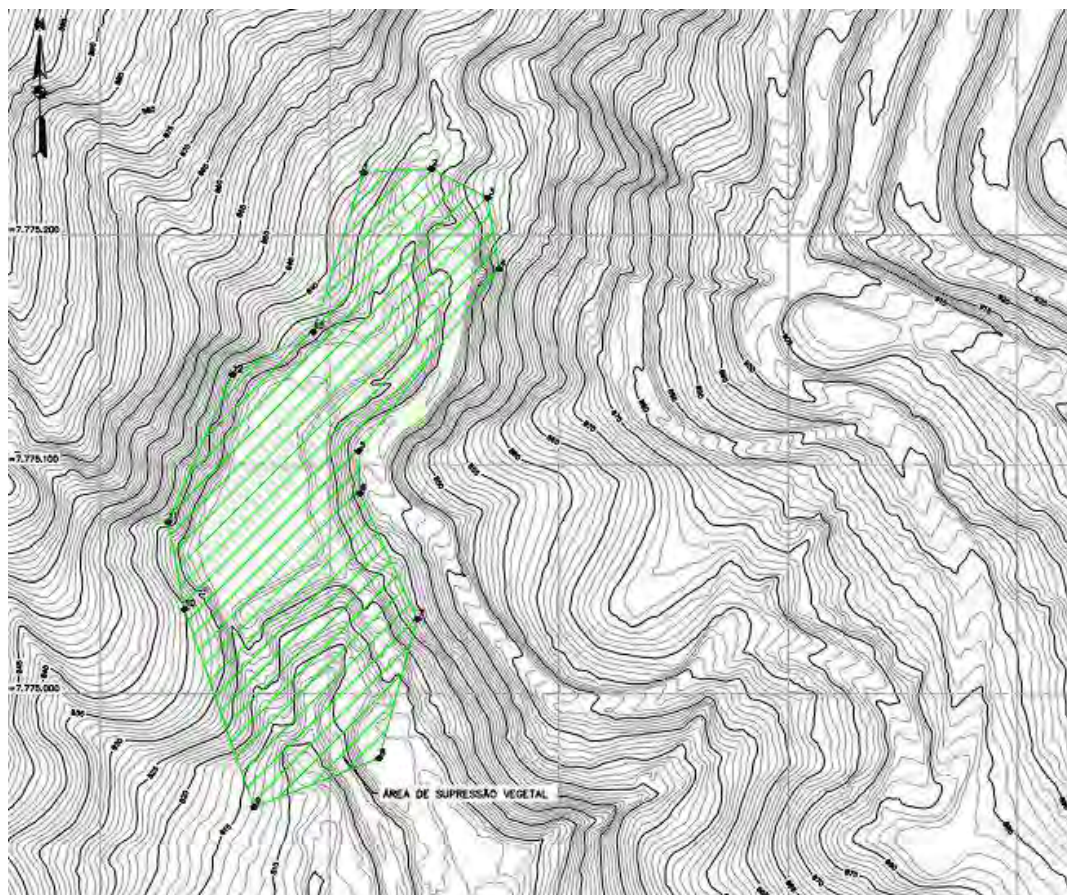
Supressão vegetal – Planta (Fonte: 1850JJ-X-31345 – BVP)
